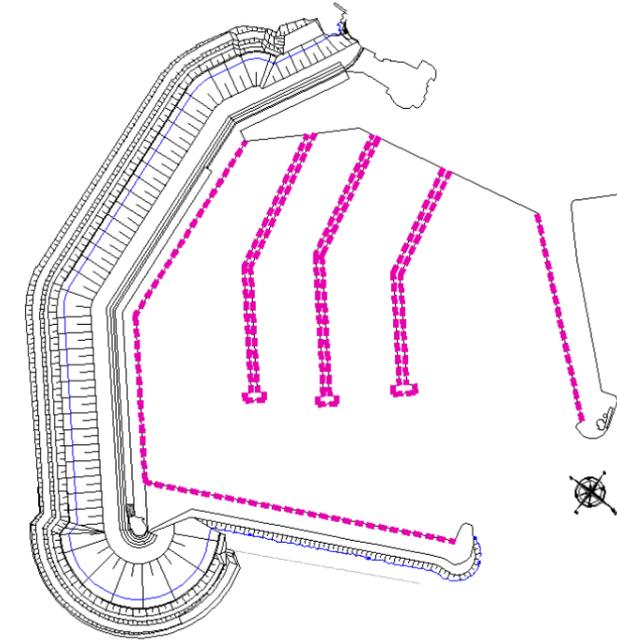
Planimetria con indicazione delle banchine ormeggiabili
